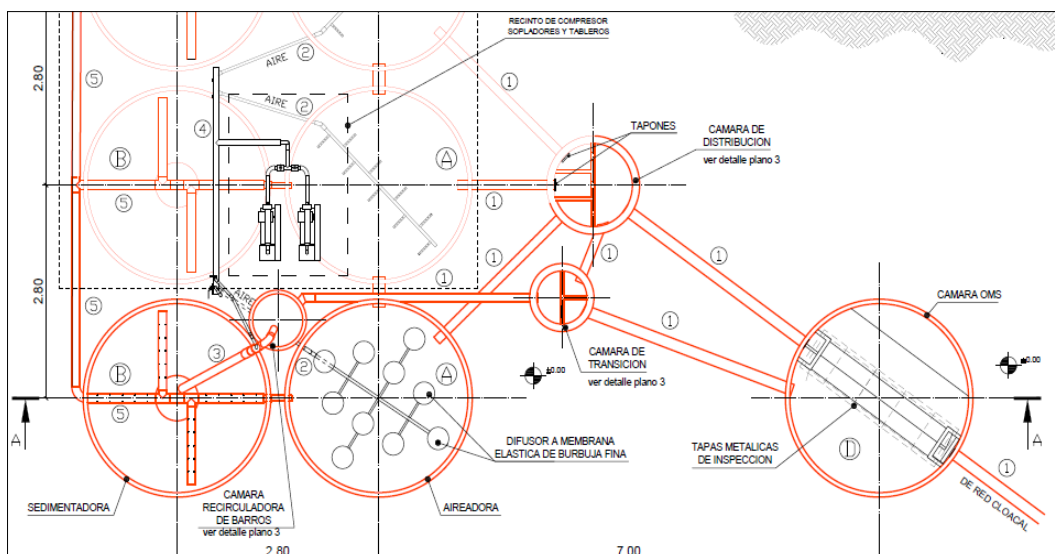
Vista en planta de la Planta de Tratamiento de Líquidos Cloacales
